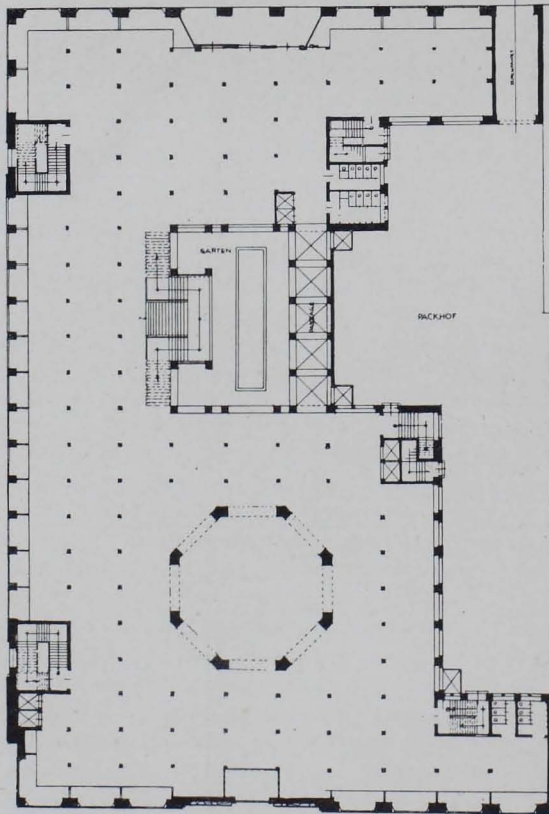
Entwurf eines Warenhauses. 1906. Grundriß des Erdgeschosses
